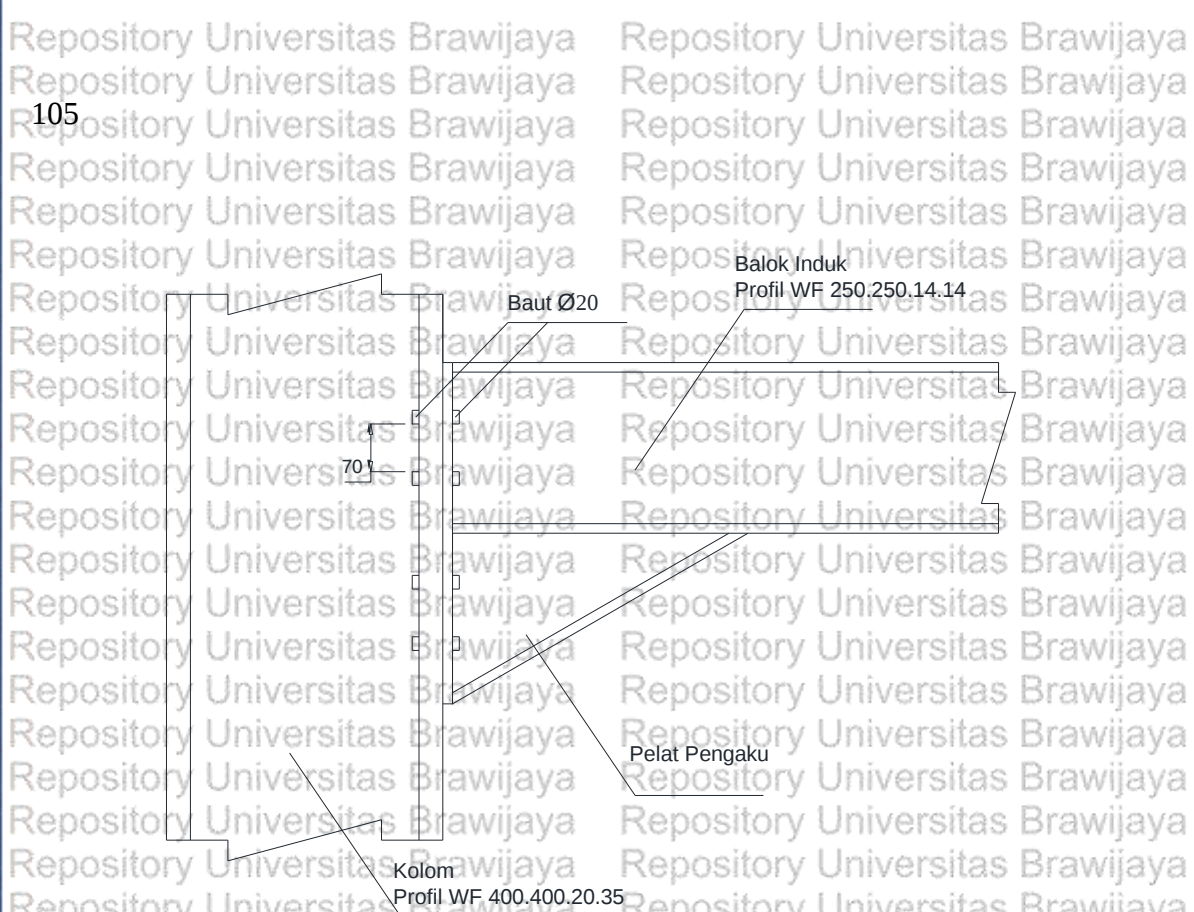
Tampak Atas Sambungan Balok Induk – Kolom
